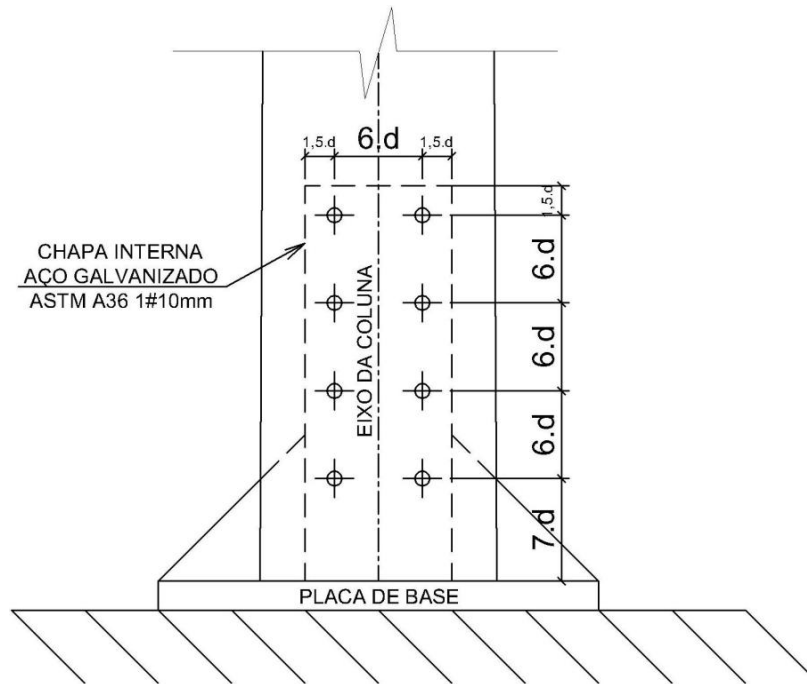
Detalhe A: Modelo genérico da conexão da placa de base enrijecida, chumbada no bloco de fundação de concreto armado, para a ligação com a base da coluna de peça roliça de madeira.
